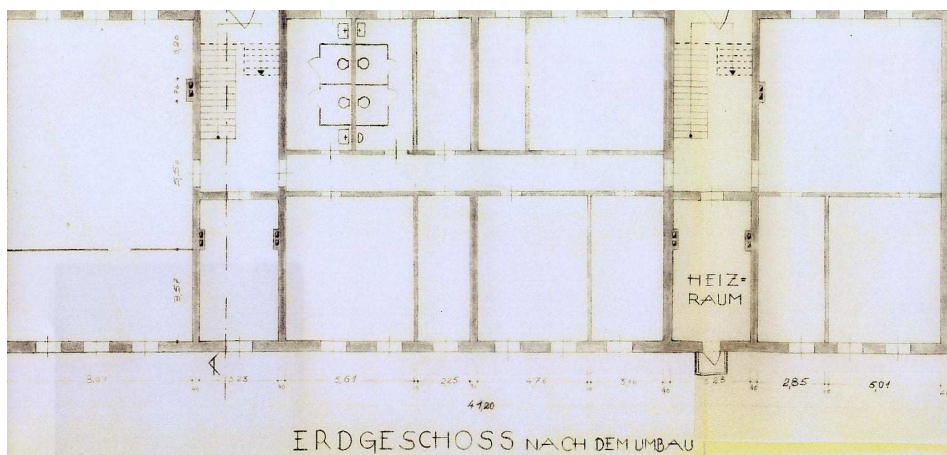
M.1 Erdgeschoß nach dem Umbau, Ausschnitt Umbauplan (undatiert)
